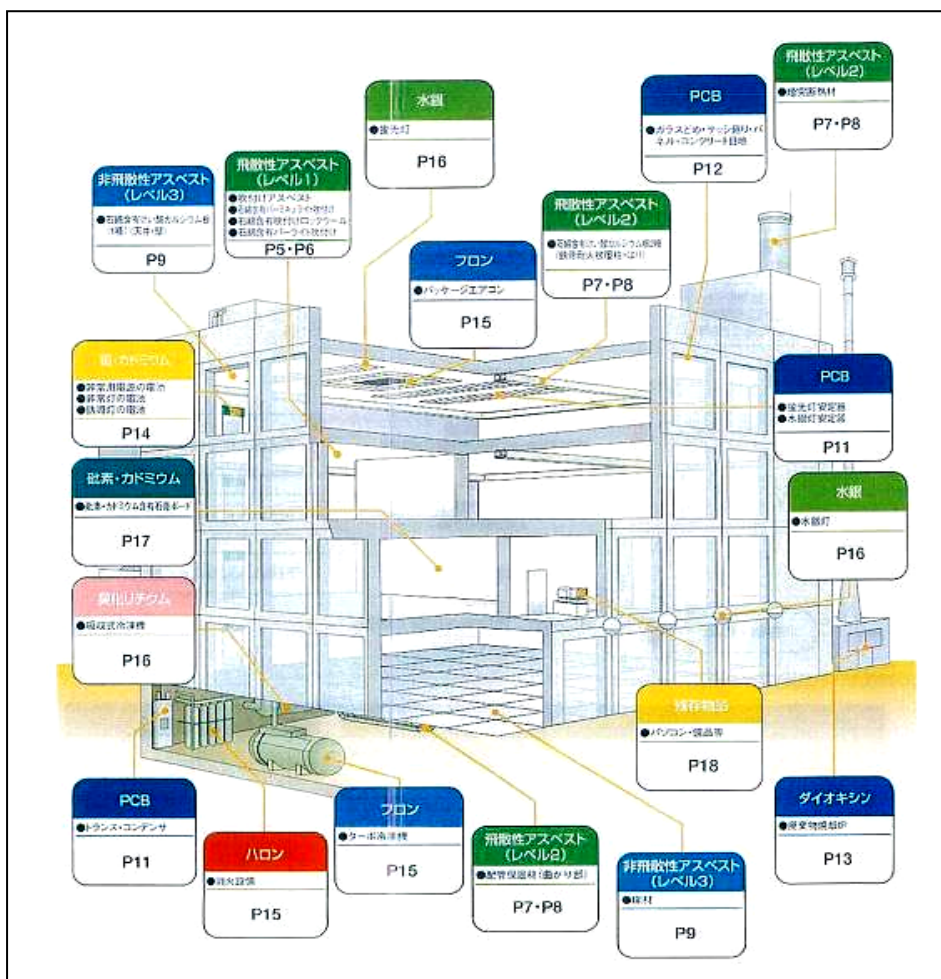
鉄筋コンクリート造建築物に含まれる有害物質の例¹¹⁾
